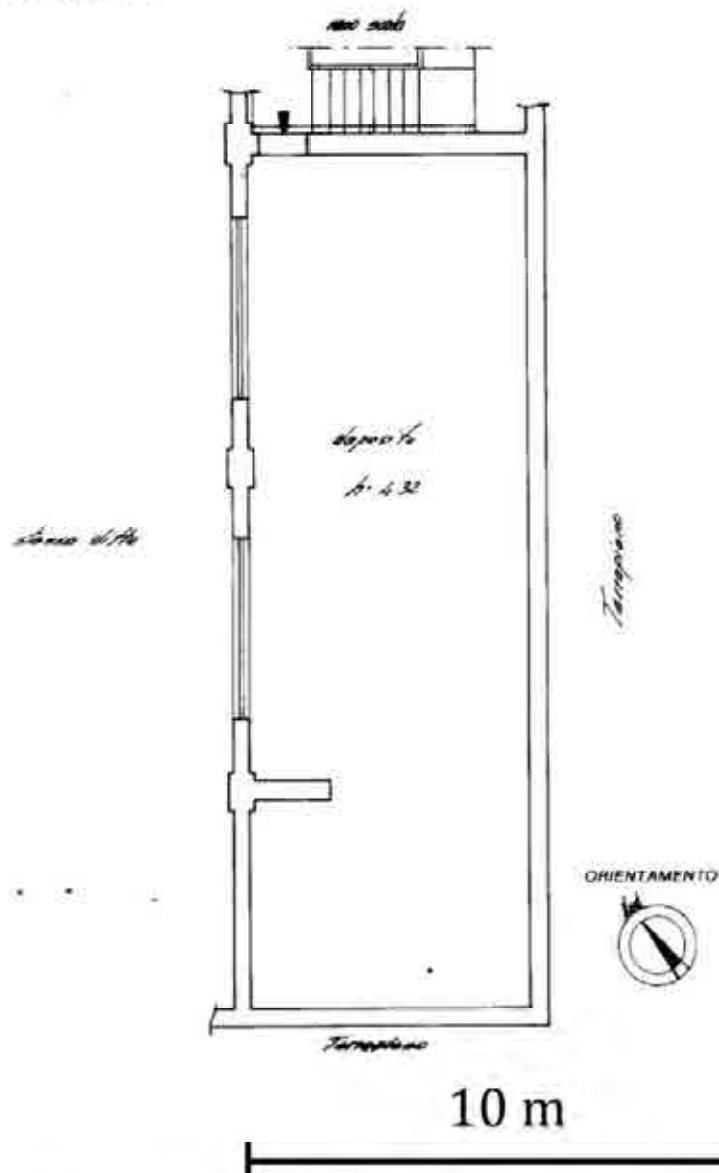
Estratto Planimetria Catastale - Magazzino NCEU [] Piano Terra
